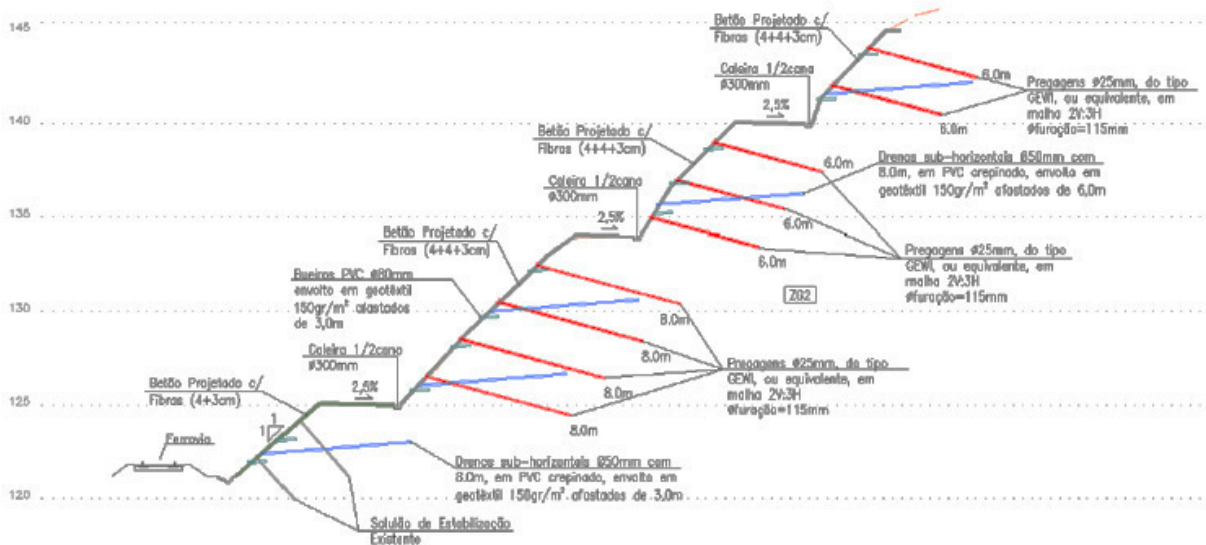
Secção tipo da solução proposta de estabilização do talude de escavação, IPE, S.A. (2015)
